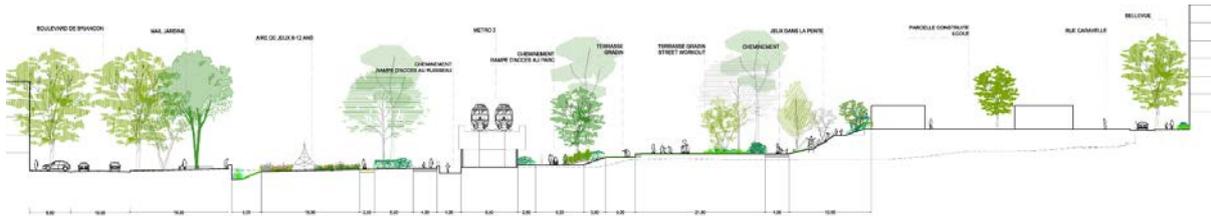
Coupe CC' du parc Bougainville (EPAEM)
